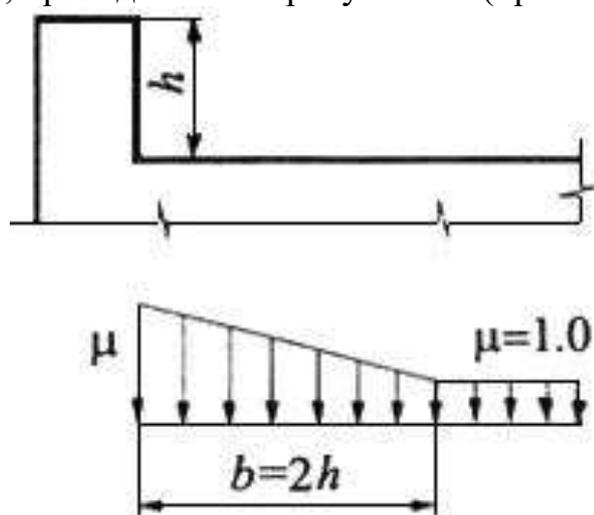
Схема нагрузки на покрытие возле парапета
